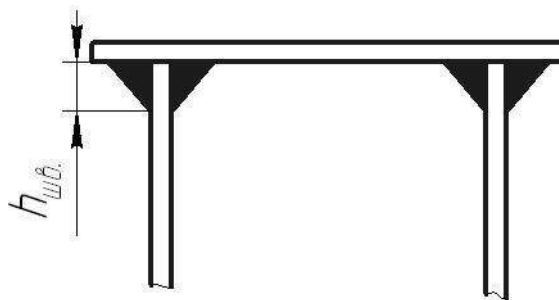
Кріплення стінок балки до верхнього поясу
